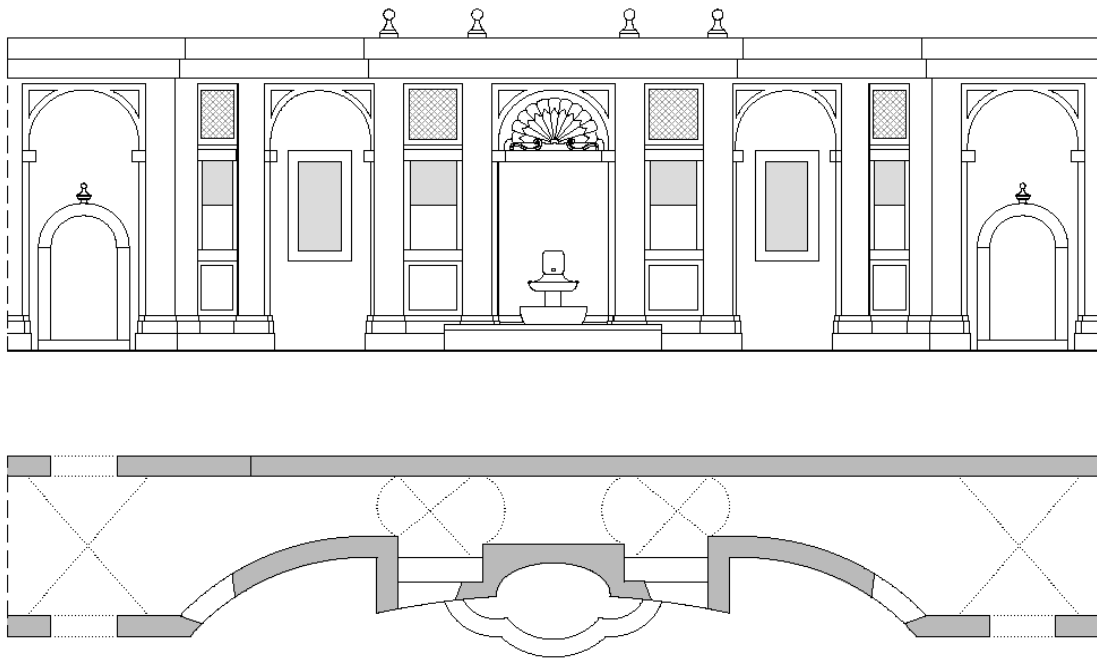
Disegno dell'autrice. Pianta e prospetto della fonte-passaggio.
